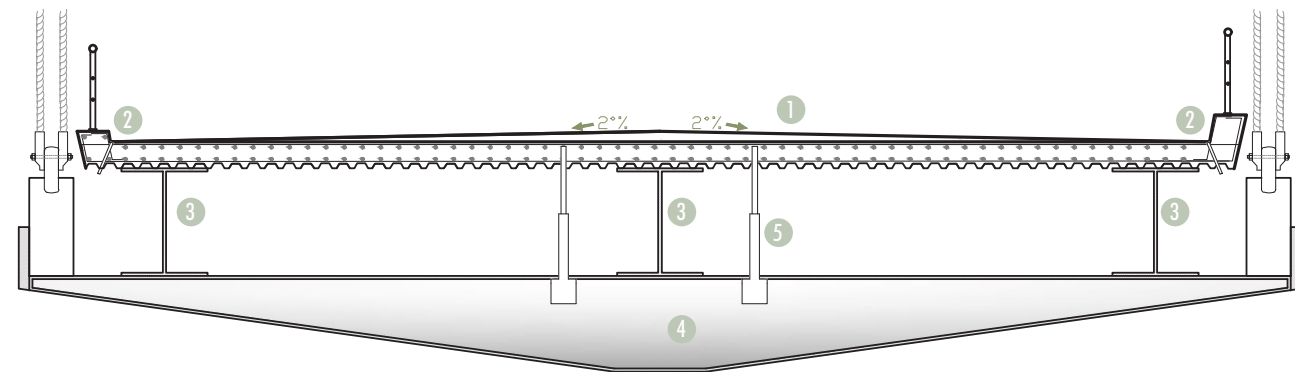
Corte por Fachada Puente de Reconexión de la Trama
